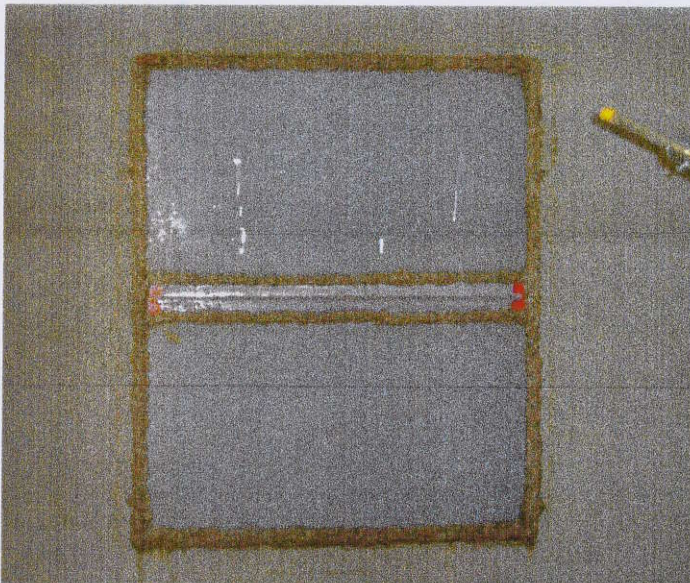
Foto des eingebauten Elementes (erstellt vom ift Schallschutzzentrum)
